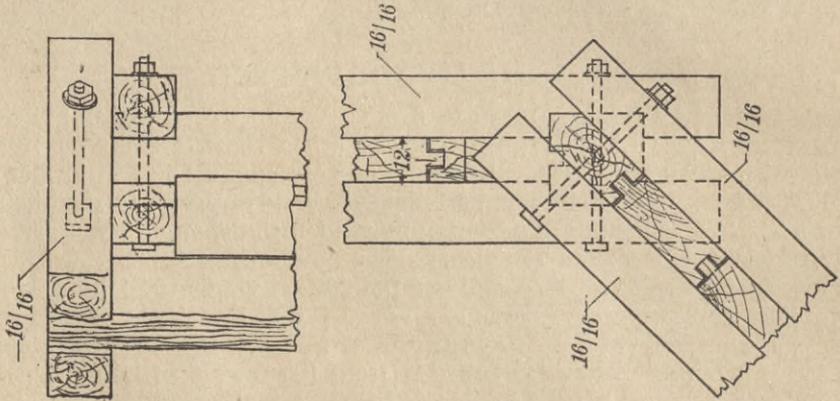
Verbindung der Spundwand-zangen mit einem Eck-Bundpfahl.
